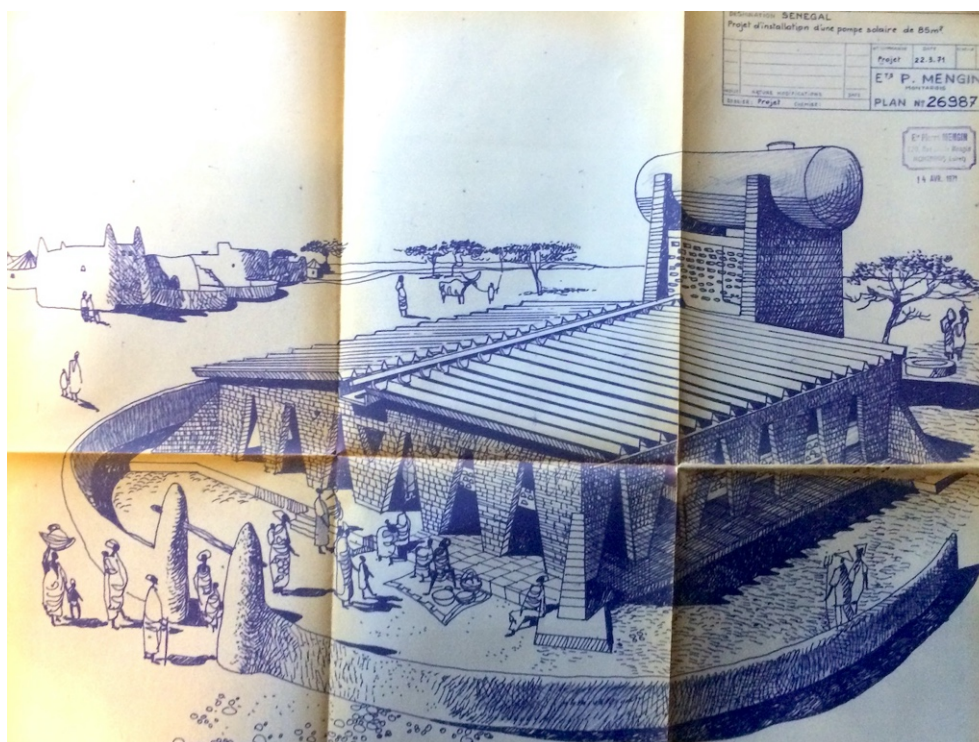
« Sénégal. Projet d'installation d'une pompe solaire de 85 m² ». Établissements Pierre Mengin, plan n° 26987, 22 mars 1971, archives privées de Georges Alexandroff.
